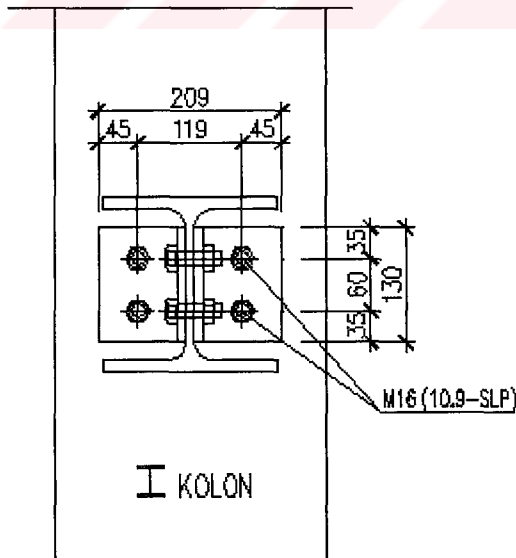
Basit bağlı kolon kiriş detayı
